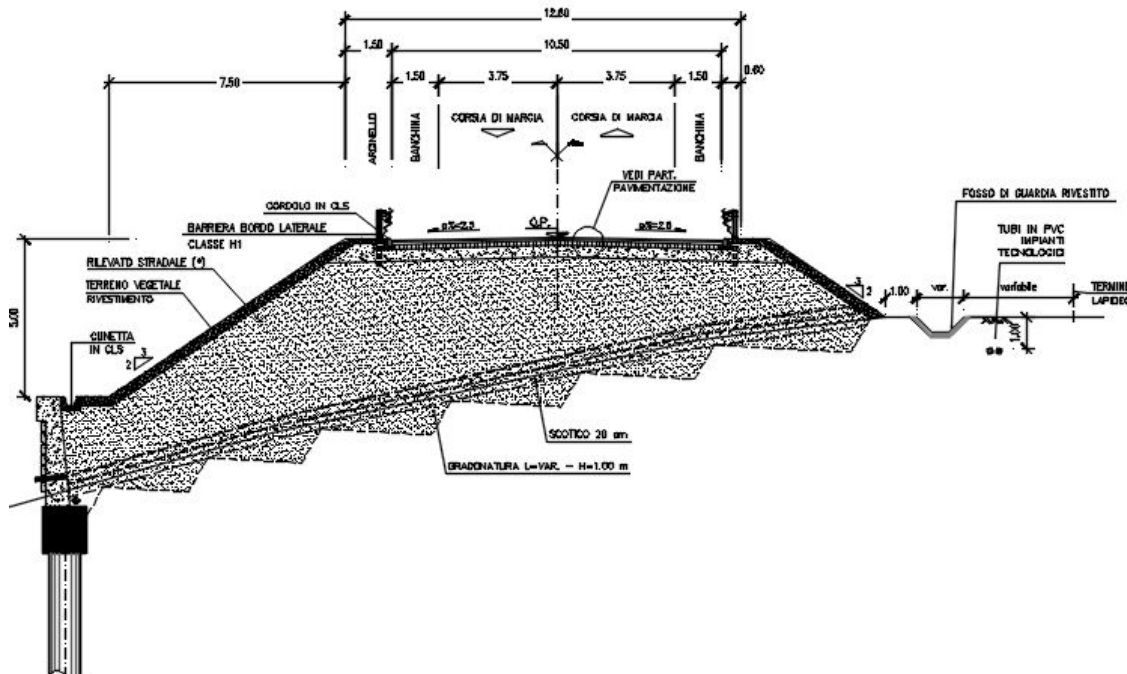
Sezione tipo in rilevato asse principale con intervento di gradonatura
